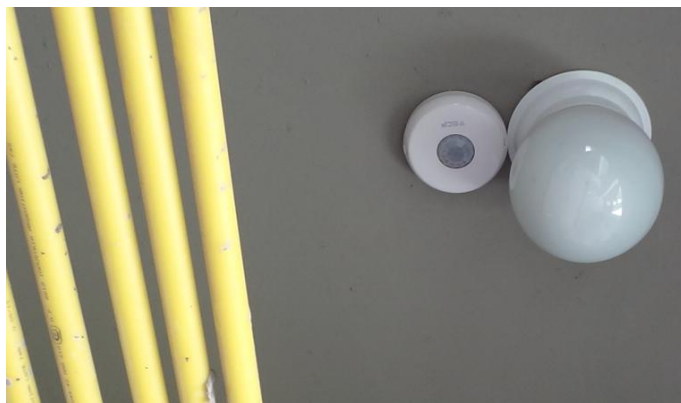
Tubulações de gás PPR e dispositivo sensor de presença para acendimento de lâmpada no pavimento térreo. Foto Erica Lemos Gil
